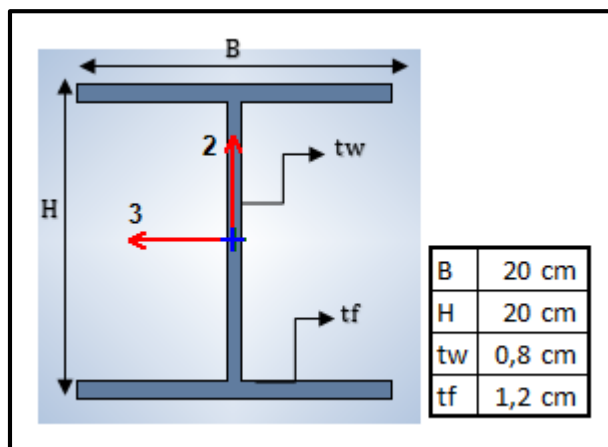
Dimensiones, Columna 4 con pórticos arriostrados.
